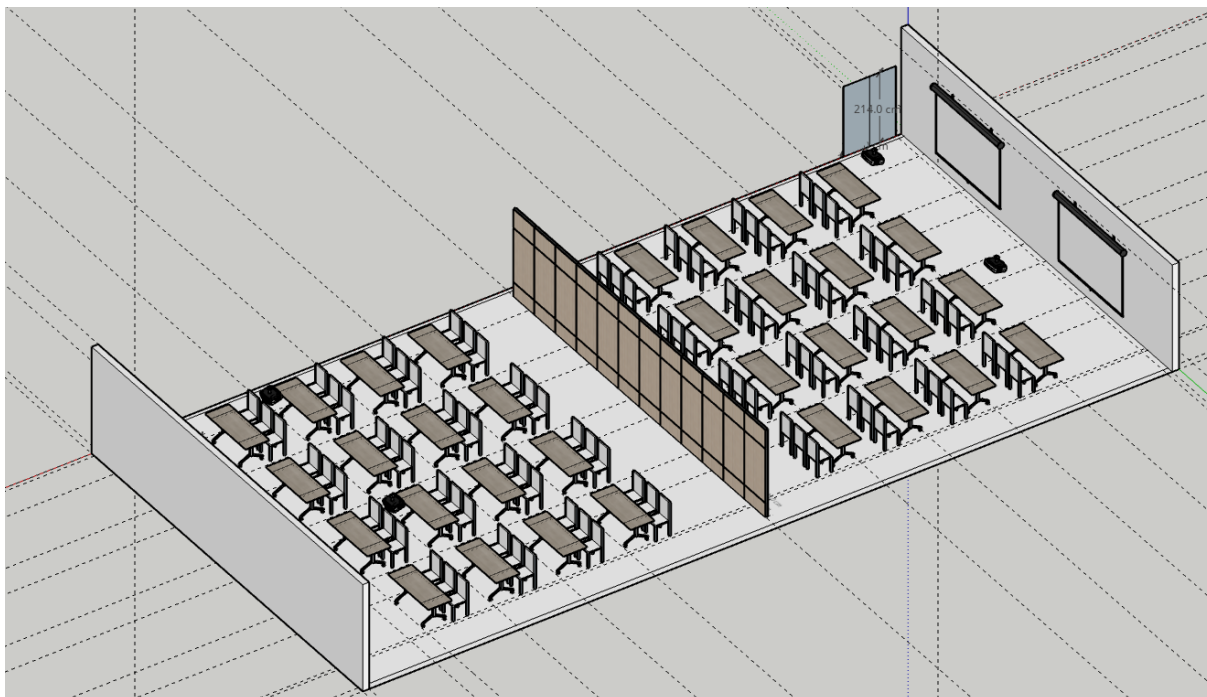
Proposta de disposição de layout das mesas e da divisória basculante
